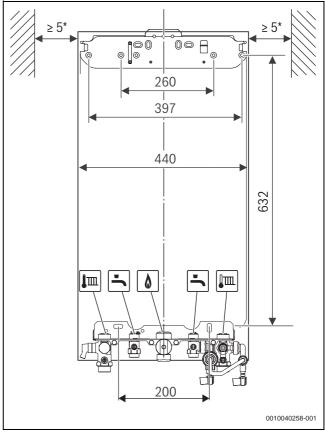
Frontansicht (Maße in mm); Montageanschlussplatte nicht im Lieferumfang
